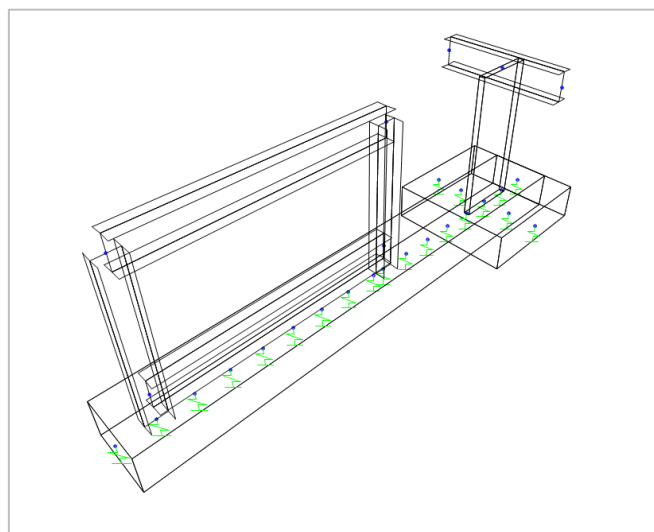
Empotramiento de viga longitudinal en viga transversal.
